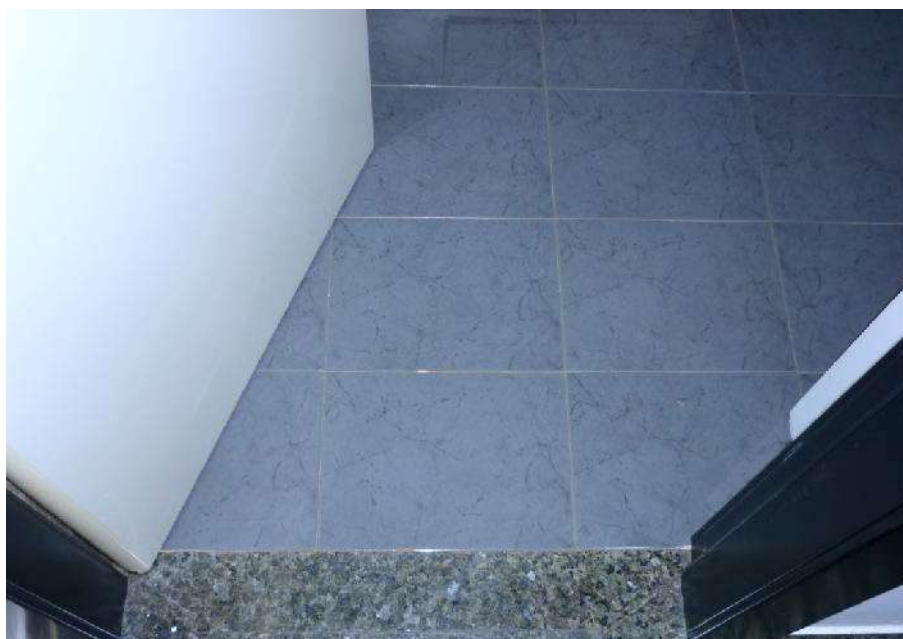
APPARTAMENTO: particolare pavimentazione camera da letto
